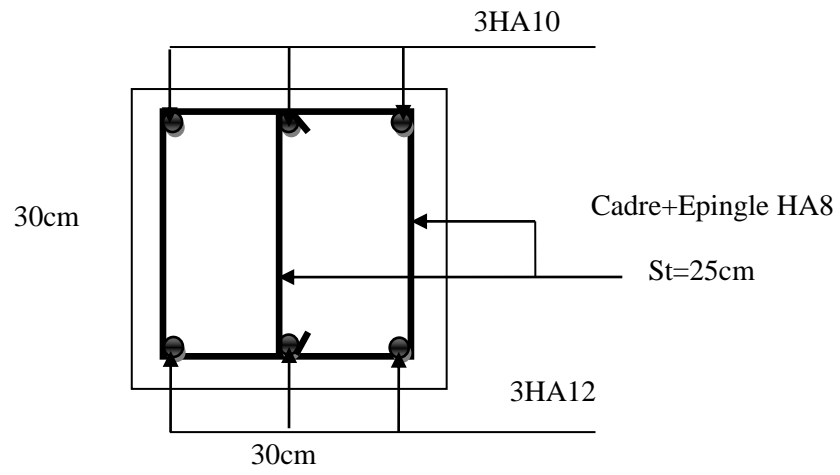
Schéma de ferrailage de la poutre de chaînage
